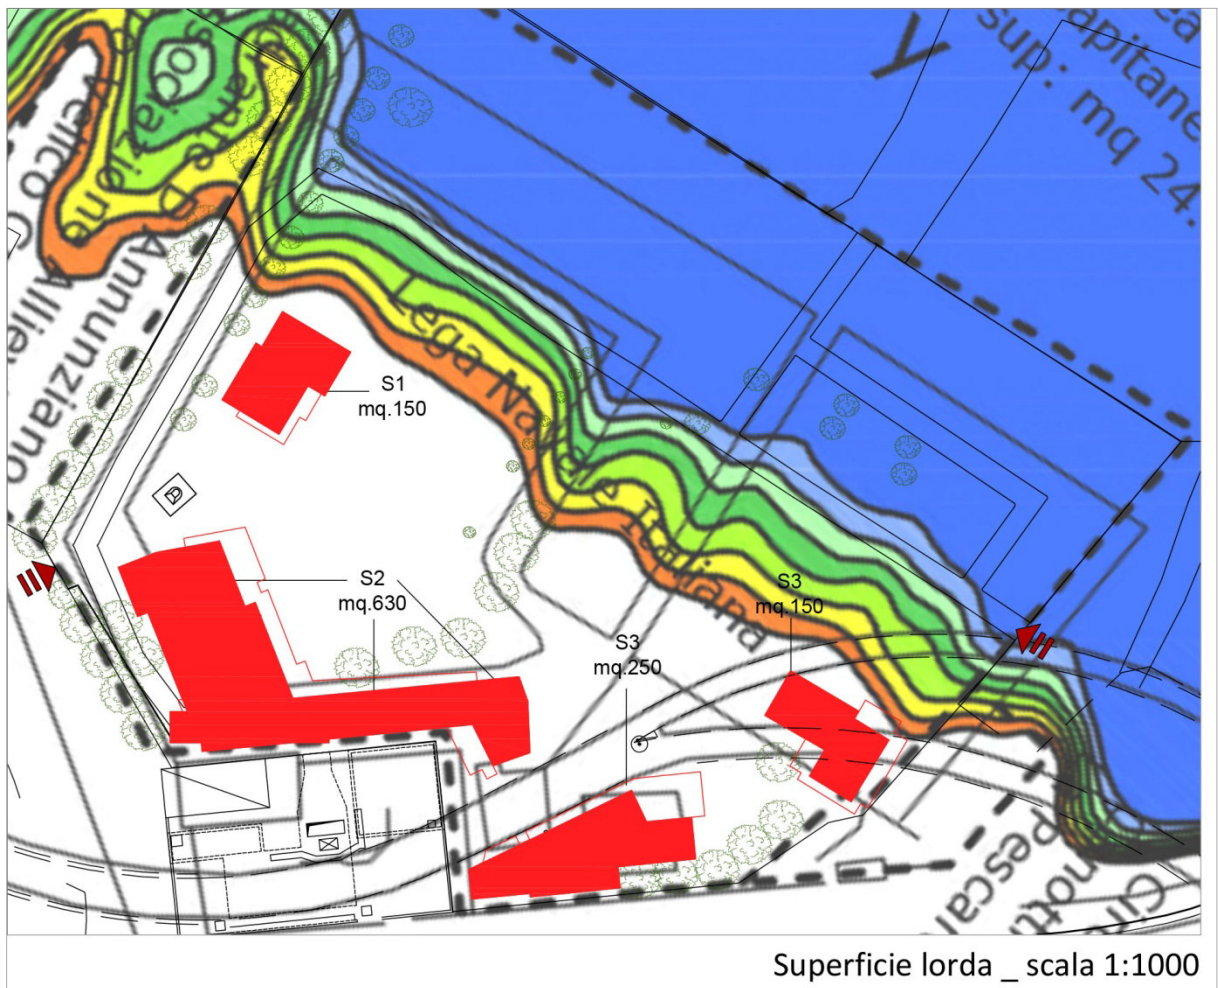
Planimetria di progetto sovrapposta alla carta di inondazione marina costiera
